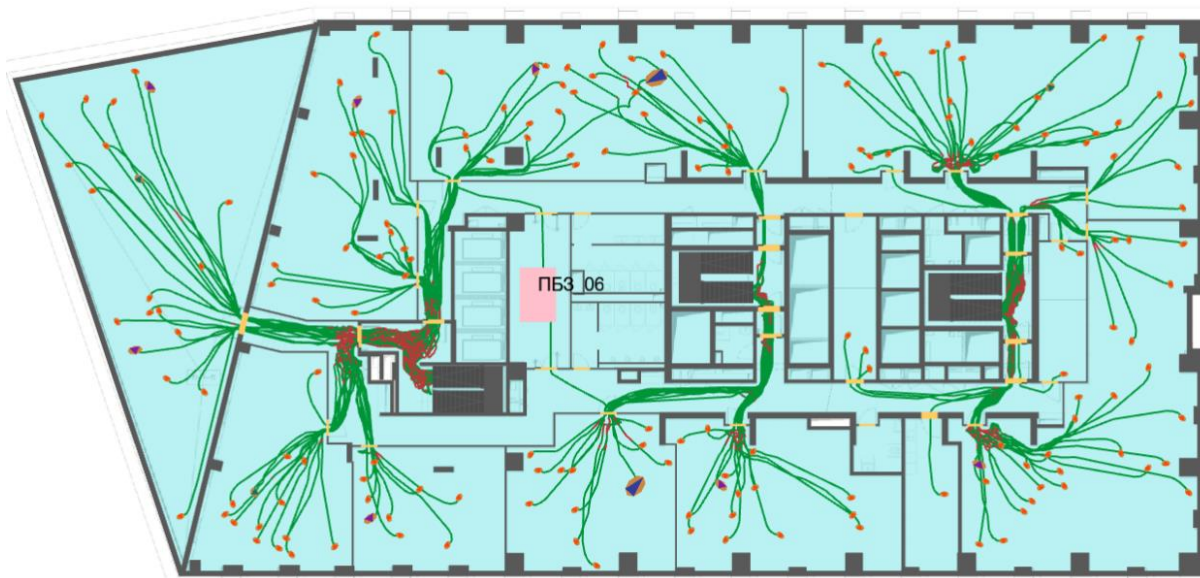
План 6-го этажа и нанесенная на него расчетная (принципиальная) схема эвакуации
